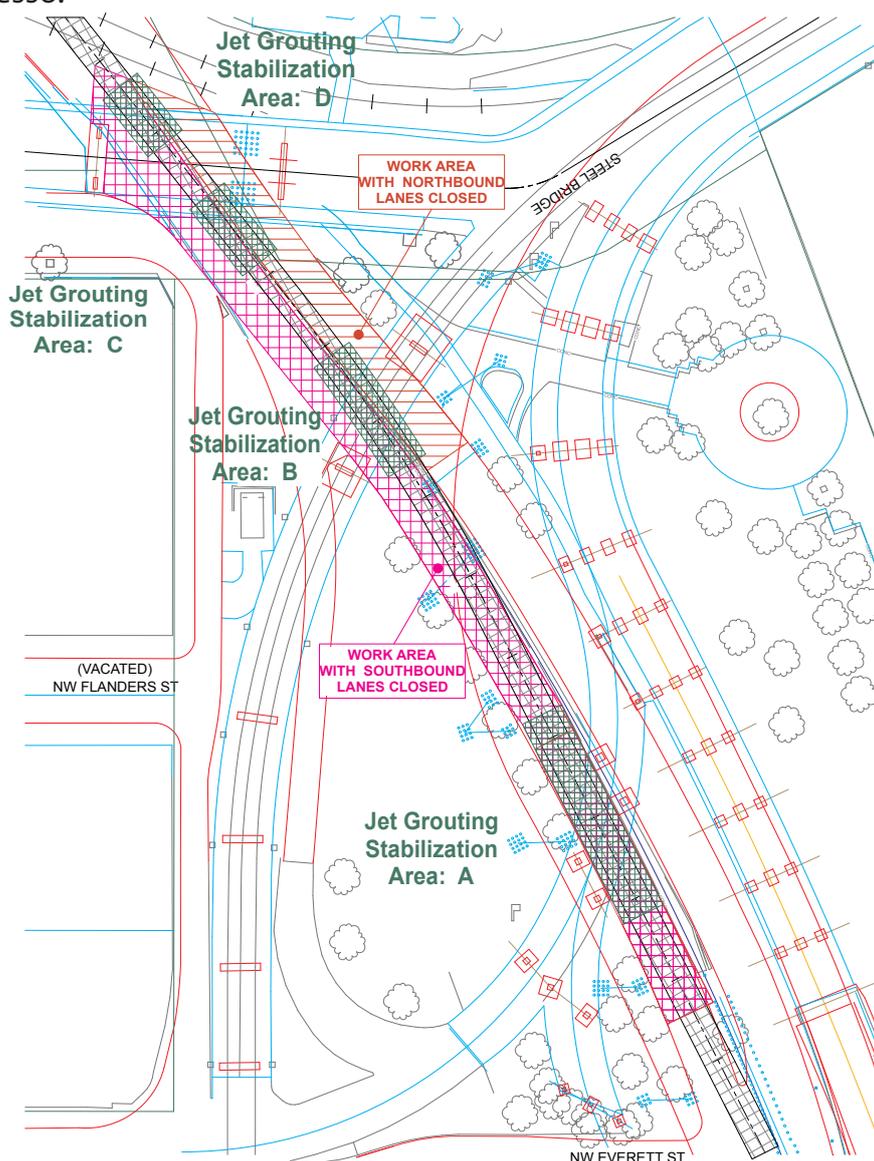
Schema topografico degli interventi a Steel Bridge.
